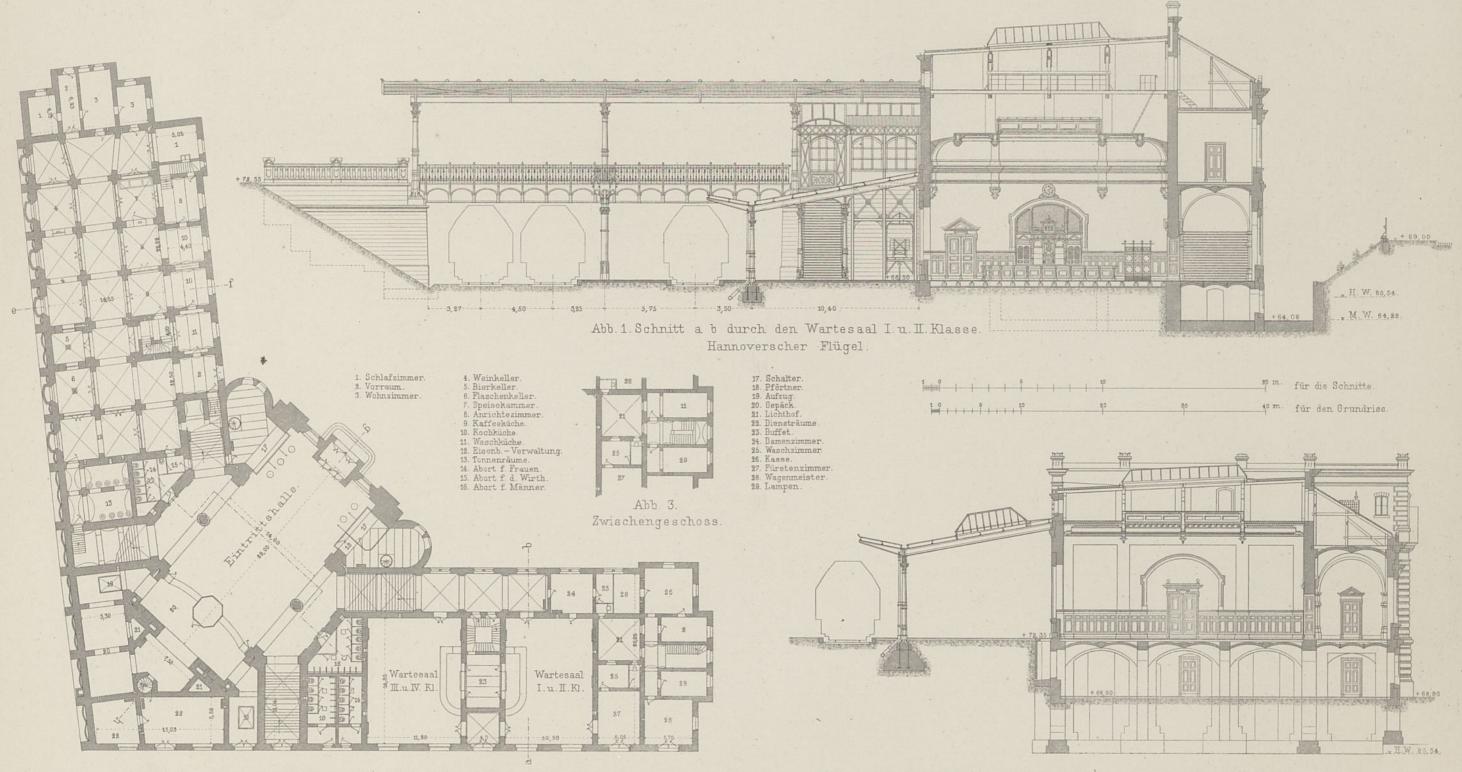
Grundriss in Höhe der Eintrittshalle.
